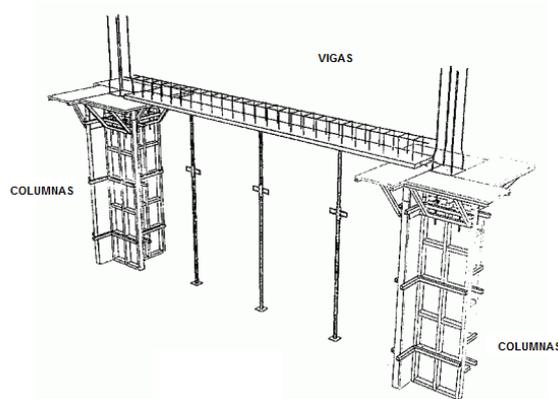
ESTRUCTURA HORMIGÓN ARMADO
